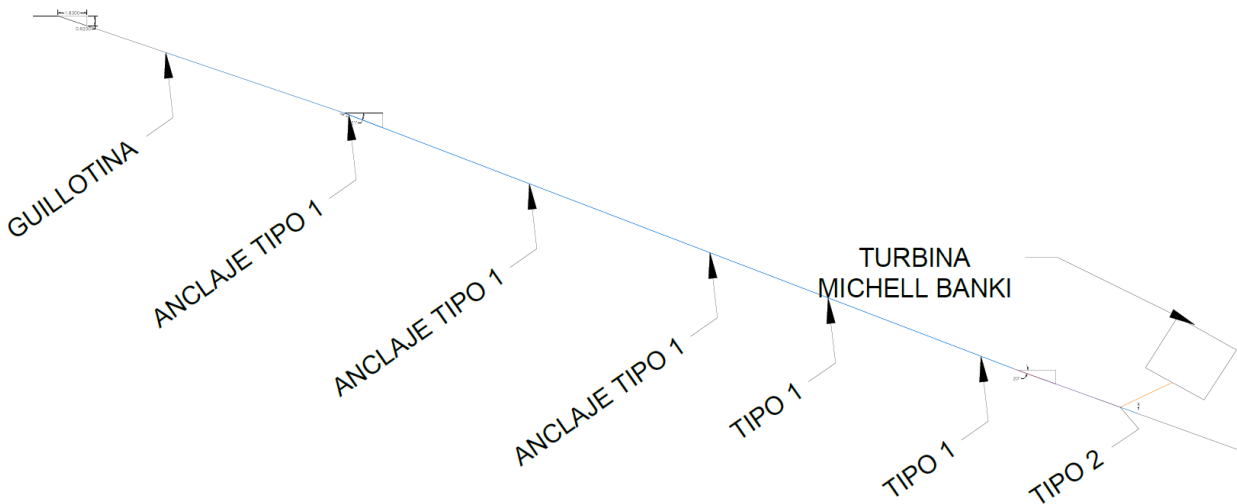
Guía de instalación de tubería línea de conducción: Plano 1.
